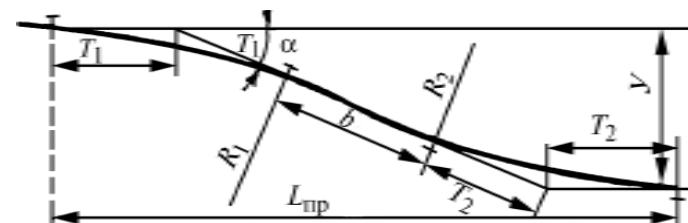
Расчетная схема к определению смещения оси пути на прямой
